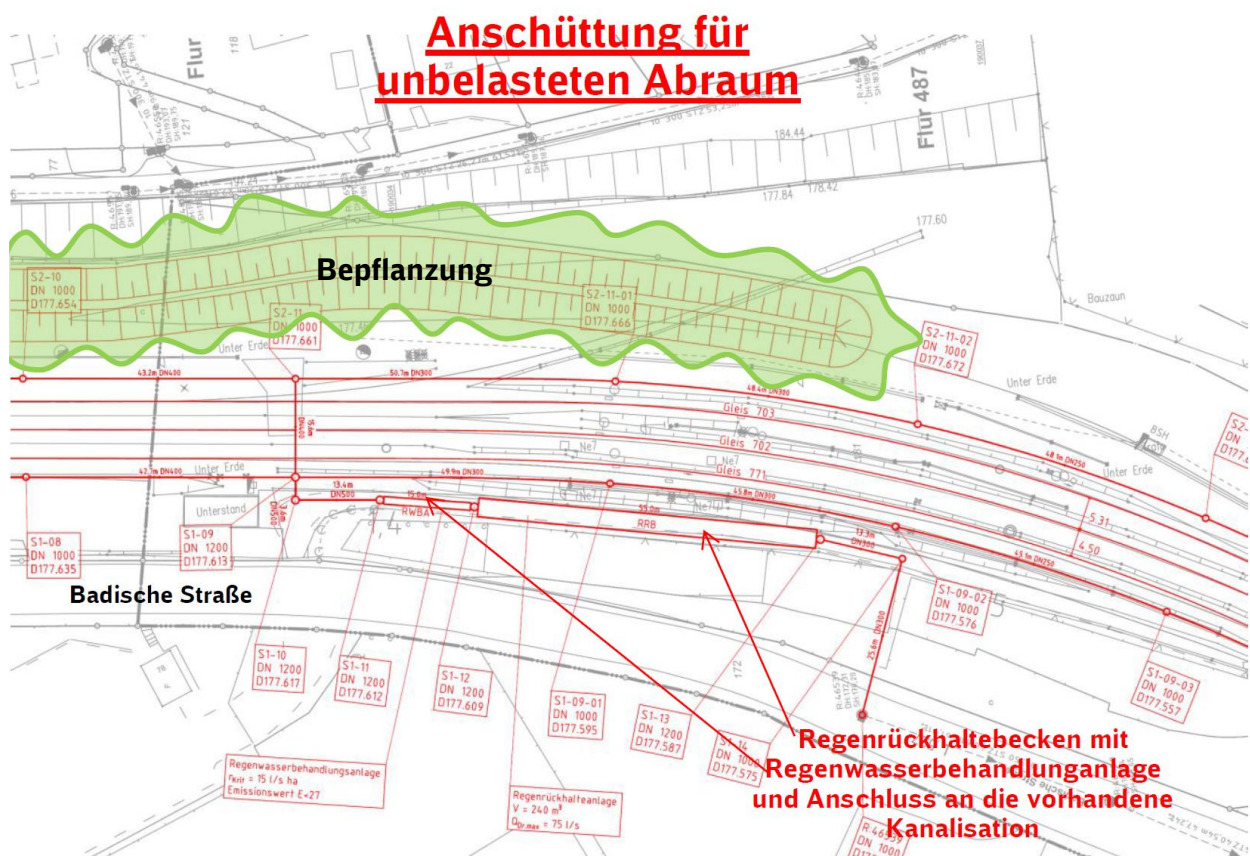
Lageplan Anschüttung und Regenrückhaltebecken
